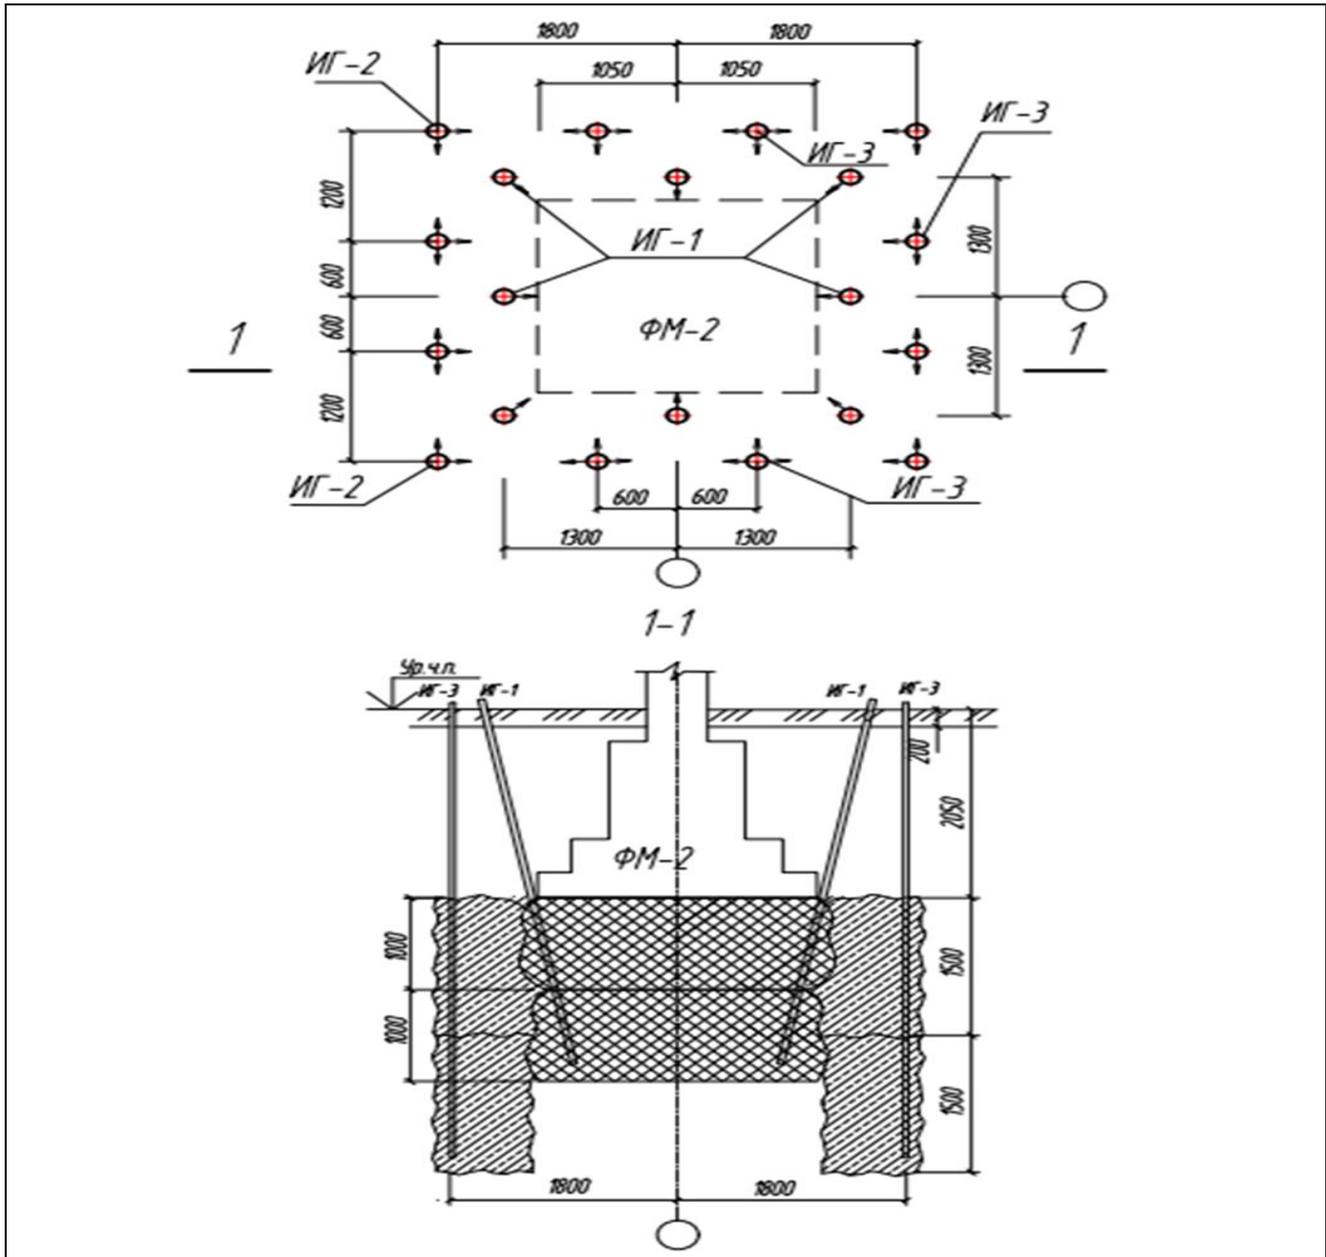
Схема инъектирования грунта основания фундамента ФМ-2
